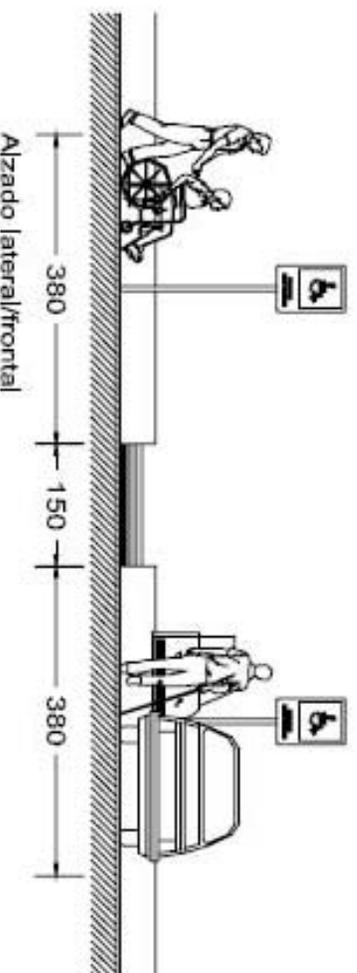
Detalle en alzado de los cajones de extracciónamiento
